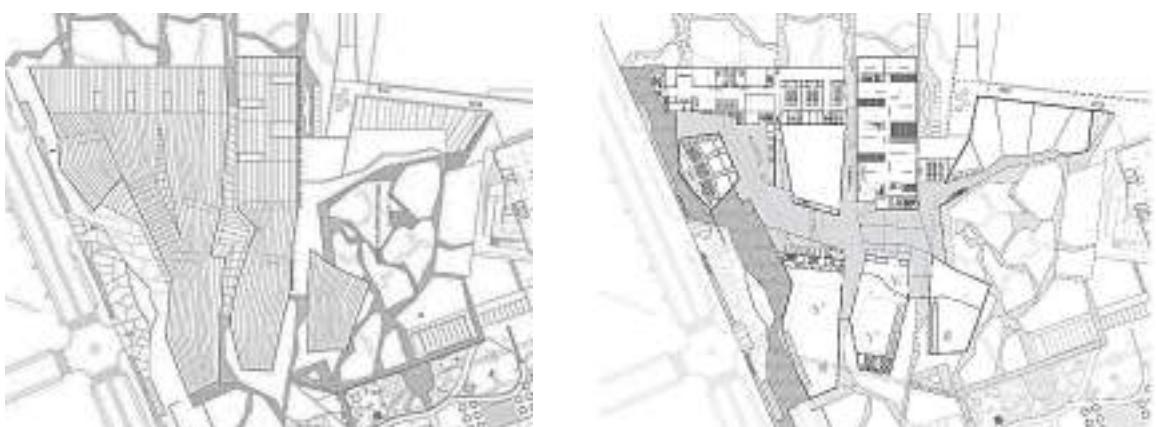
1-2. Planimetría del conjunto y planta a nivel de acceso.
